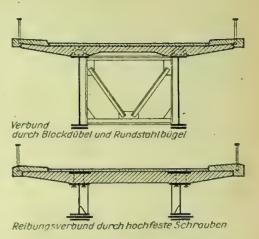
Stahlverbundkonstruktionen
